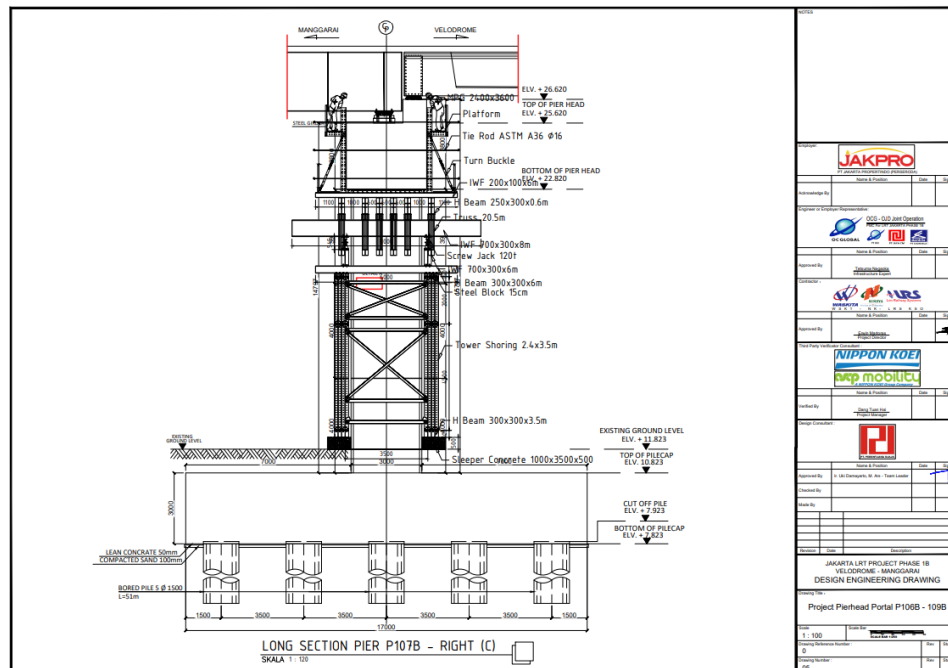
Layout Shoring Pier P107B Tahap 2
